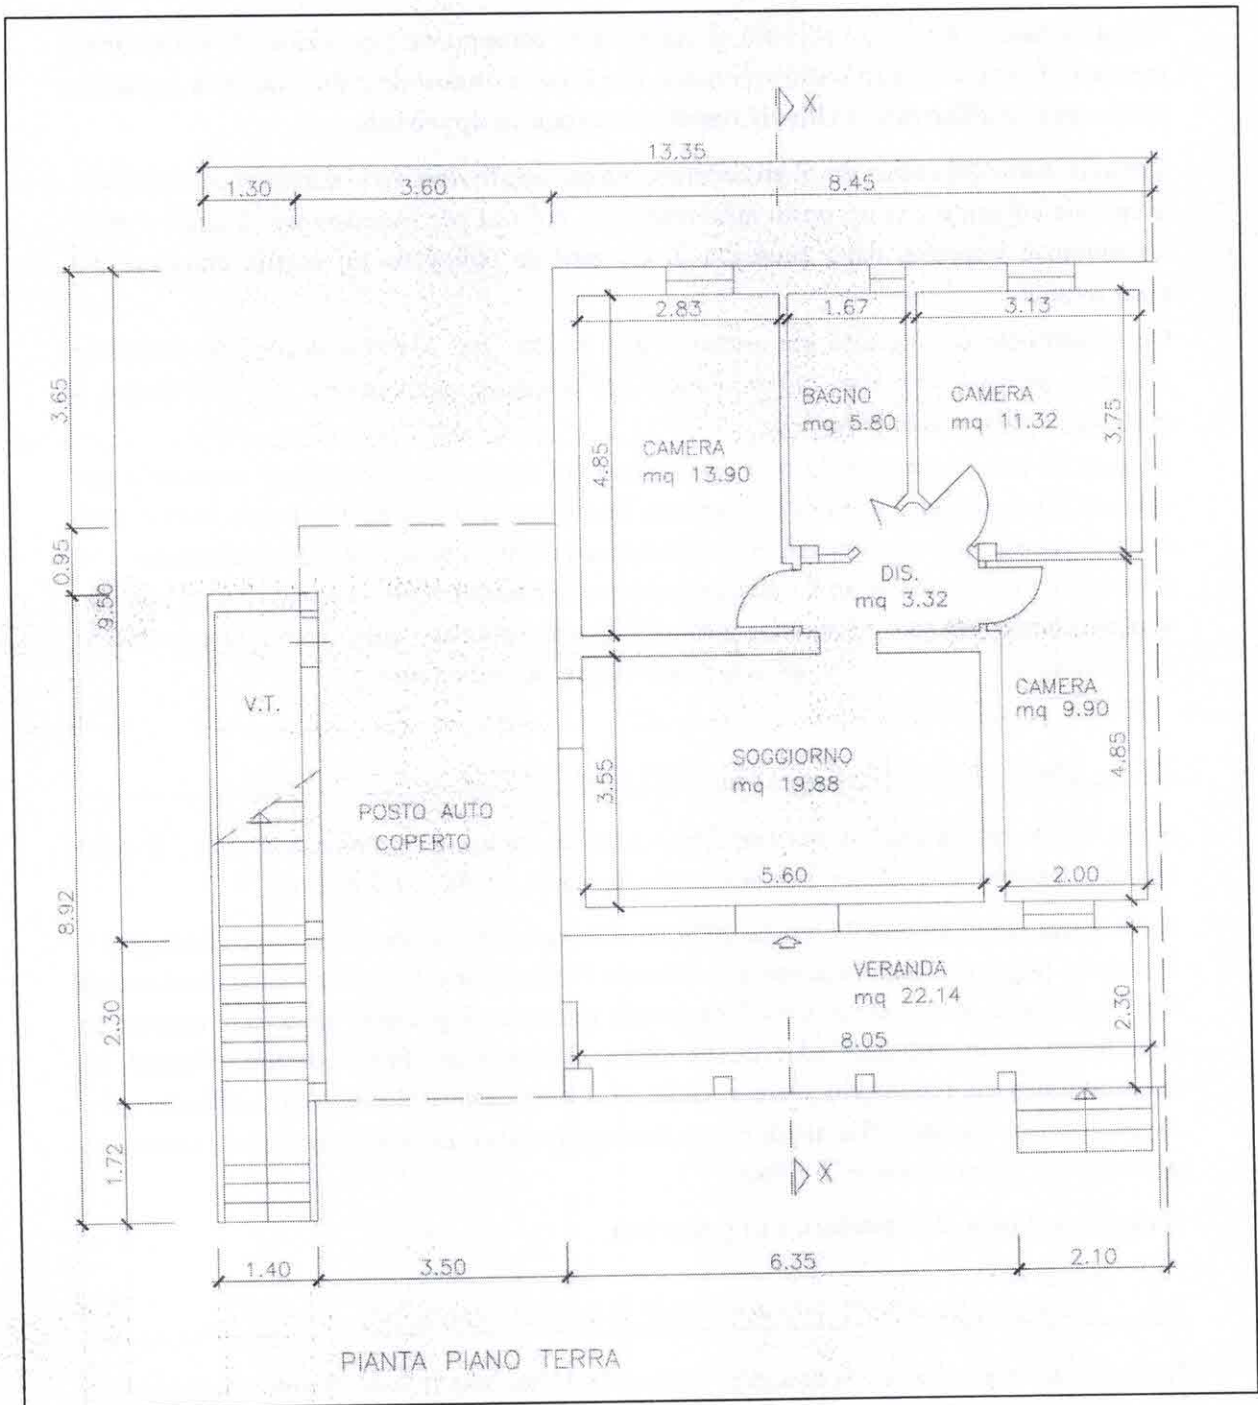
Subalterno 2 – Piano Terra – Planimetria stato di progetto – Variante in corso d'opera del 2009
